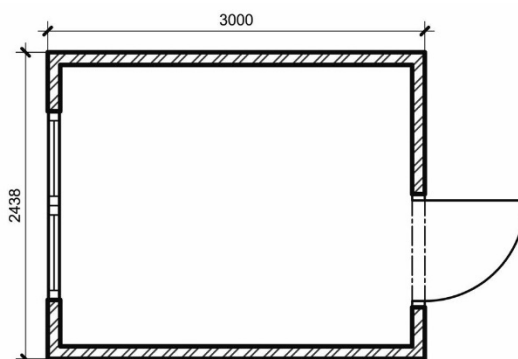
Půdorys stavebního kontejneru typu LK1 [10]
